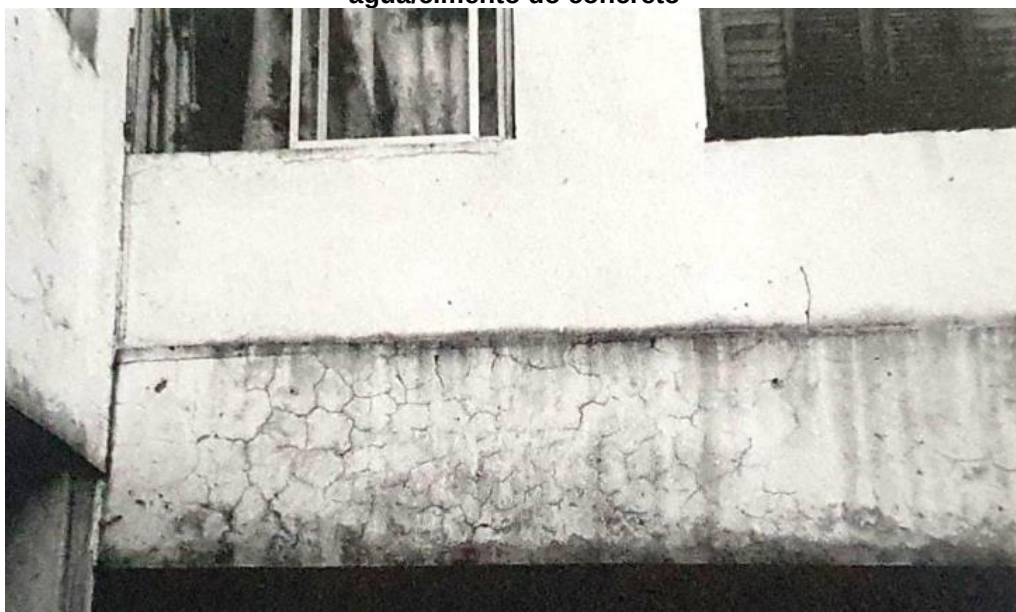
Fissuras de retração numa viga alta de concreto armado com deficiente armadura de pele
